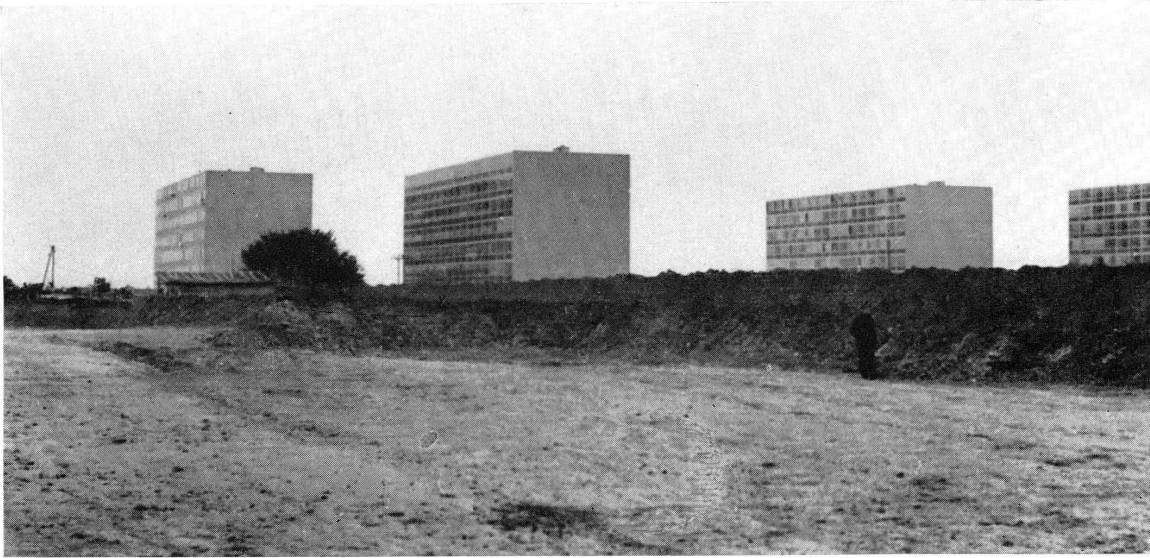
Meyrin. Cité satellite. Vue de l'emplacement du cul-de-sac du segment de galerie II (devant le personnage). Au fond les quatre immeubles du côté NE; au premier plan le terrassement de la rue des Boudines.
